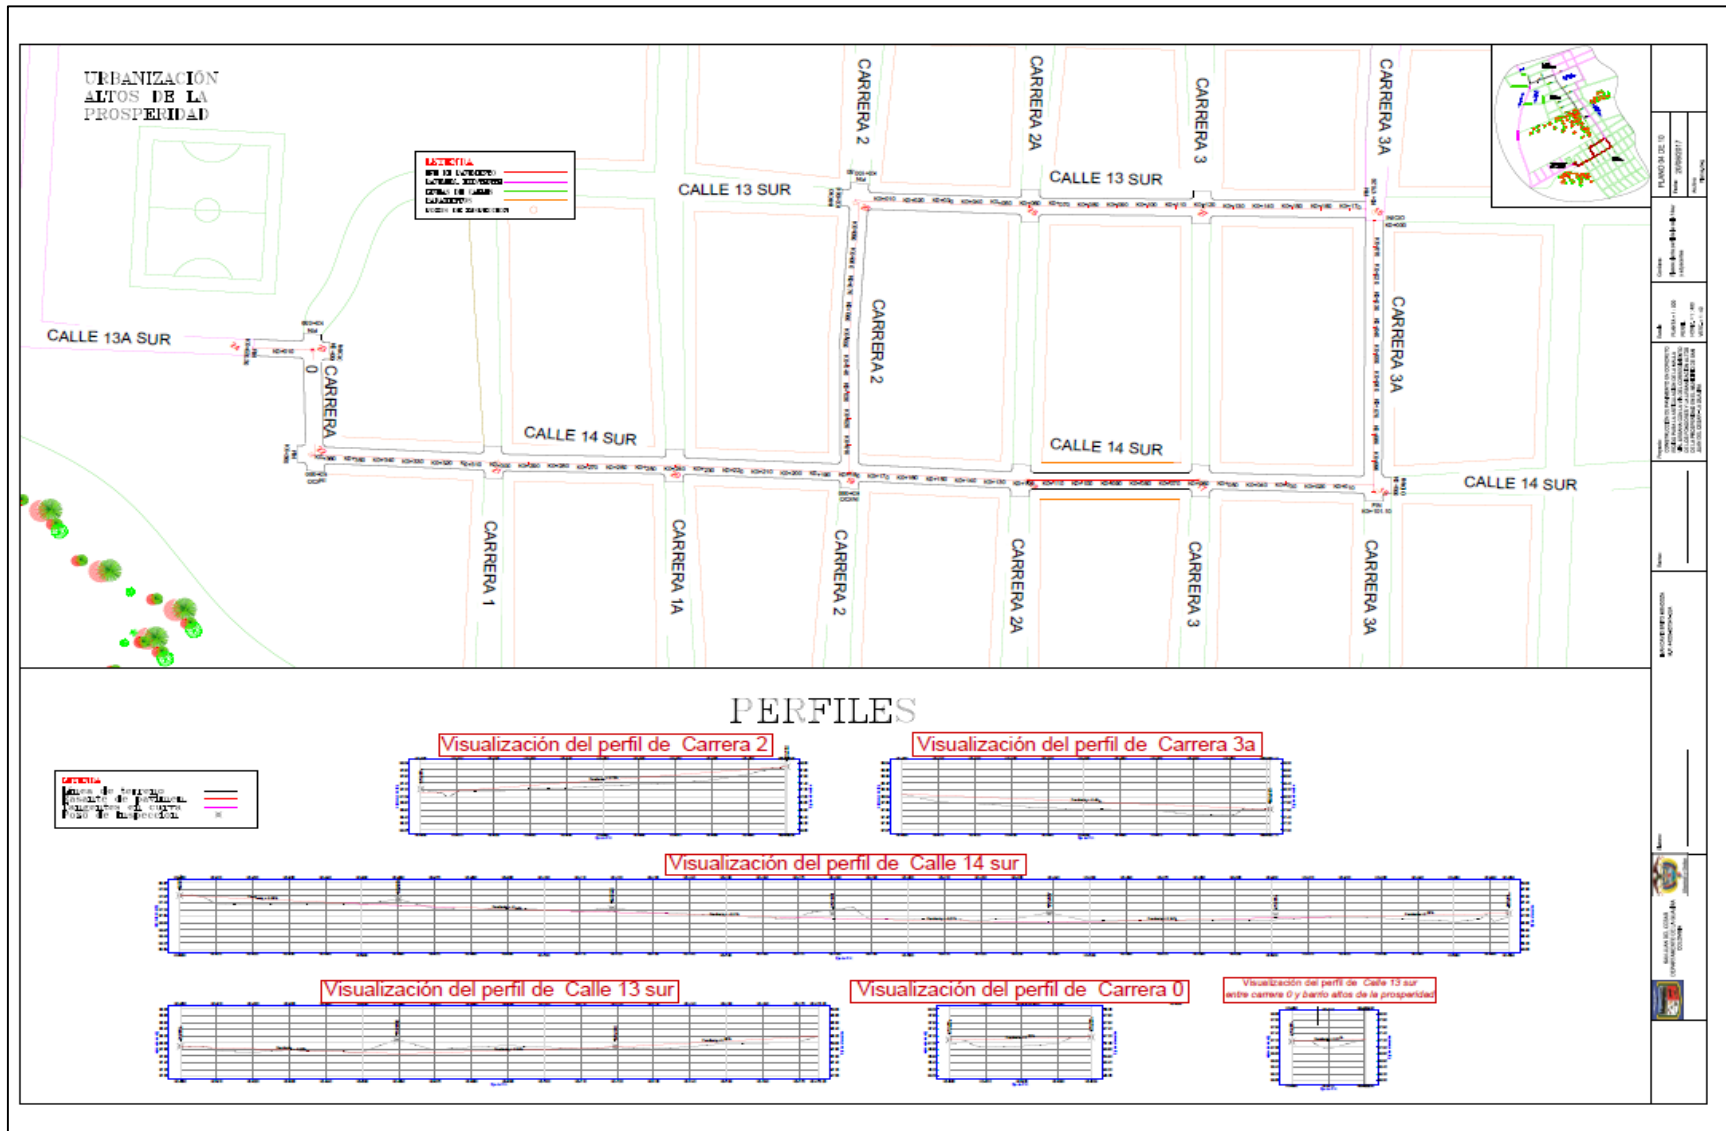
Plano del proyecto Calle 14 Sur. Fuente: (G24 SAS, 2019)
